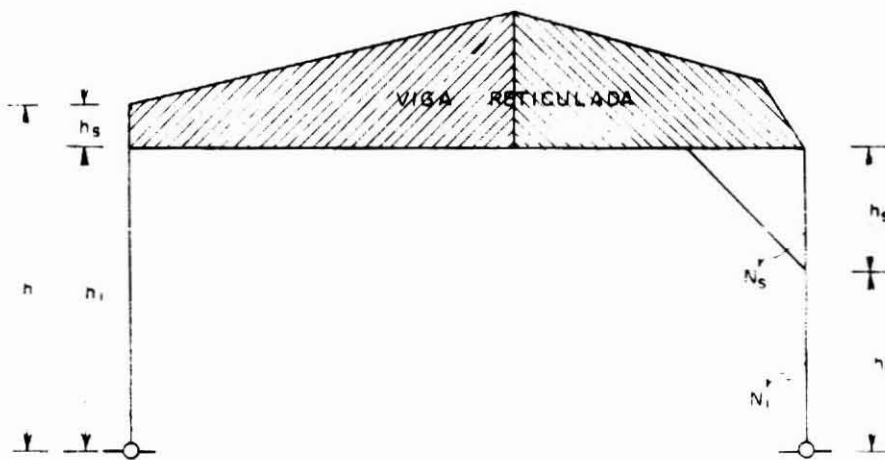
Longitud de pandeo en marcos con vigas reticuladas.
